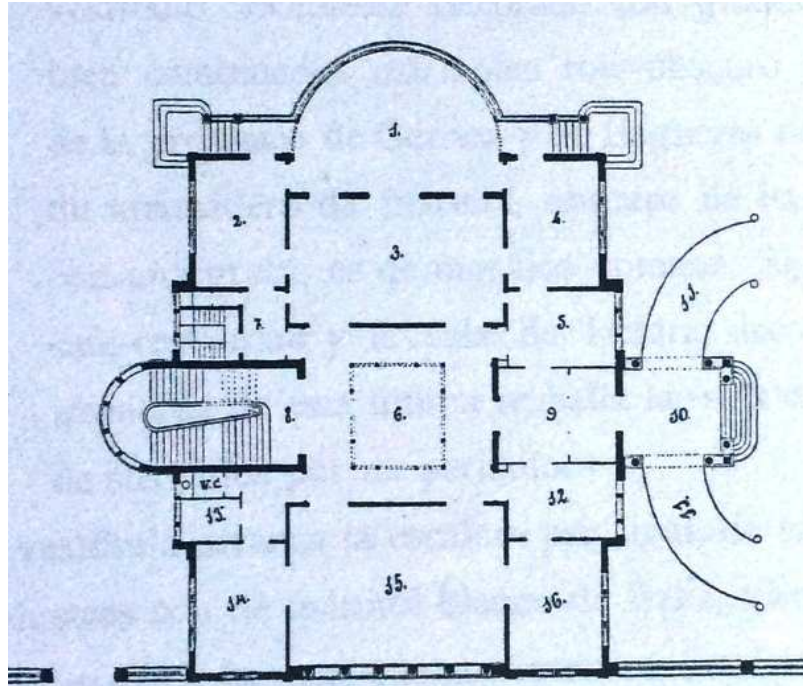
Fig. IV.CVI. Planta baja del Palacio Simón: 1=Rotonda acristalada; 2=Sala de billar; 3=Comedor; 4=Biblioteca; 5=Despacho; 6=Patio acristalado (*Atrium-Impluvium*); 7=Escalera y escusado de servicio; 8=Escalera principal; 9=Vestíbulo; 10=Marquesina; 11=Paso de carruajes; 12=Sala de labor; 13=Lavabo y W.C.; 14=Salón de Piano; 15=Gran Salón; 16=Salón de confianza [ROGENT i PEDROSA, F. (1897), Op. cit., p.69].
